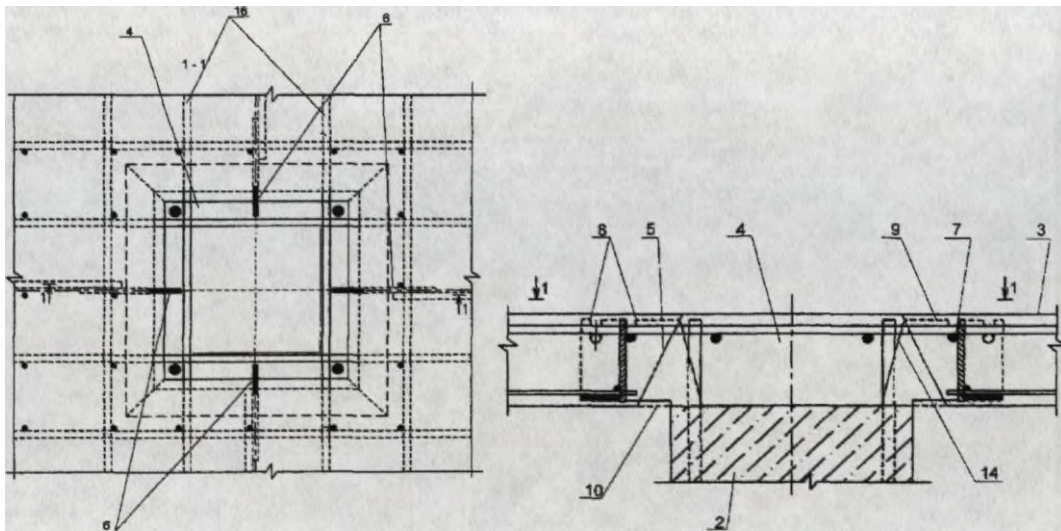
Вузол стику плити перекриття з монолітною колоною; 2 – монолітна колона; 3 – надколонна плита перекриття; 4 – отвір плити перекриття; 5 – грань отвору плити перекриття; 6 – трапеціїдальні металеві пластини; 7 – силова арматура плити перекриття; 8 – монтажні пази; 9 - ребро малої основи трапеції; 10 - ребро більшої основи трапеції; 11 – закладна деталь; 12 – силова арматура; 13 – бокове ребро пластини; 14 – косе бокове ребро; 15 - бетон
